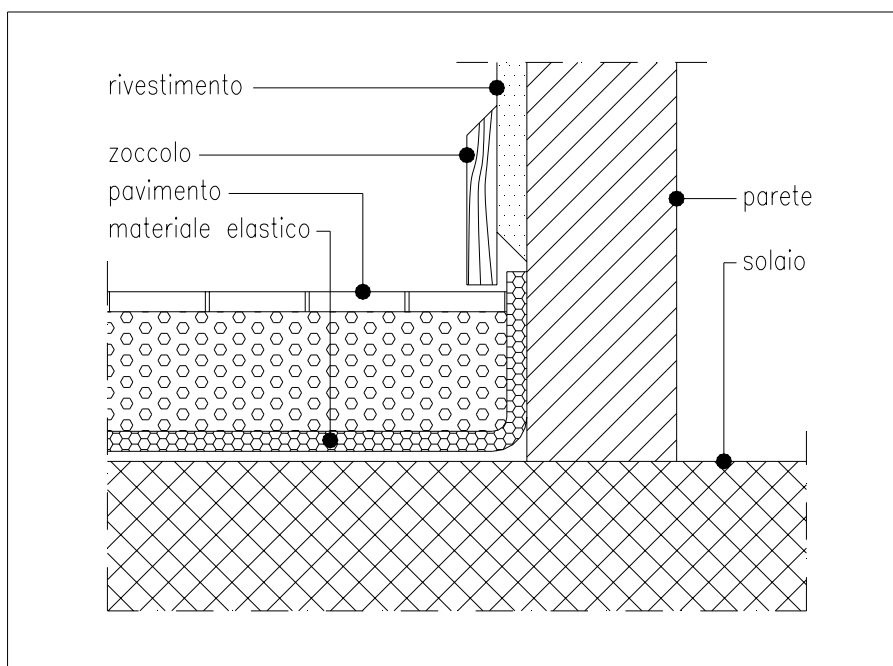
Schema di realizzazione di un pavimento galleggiante
